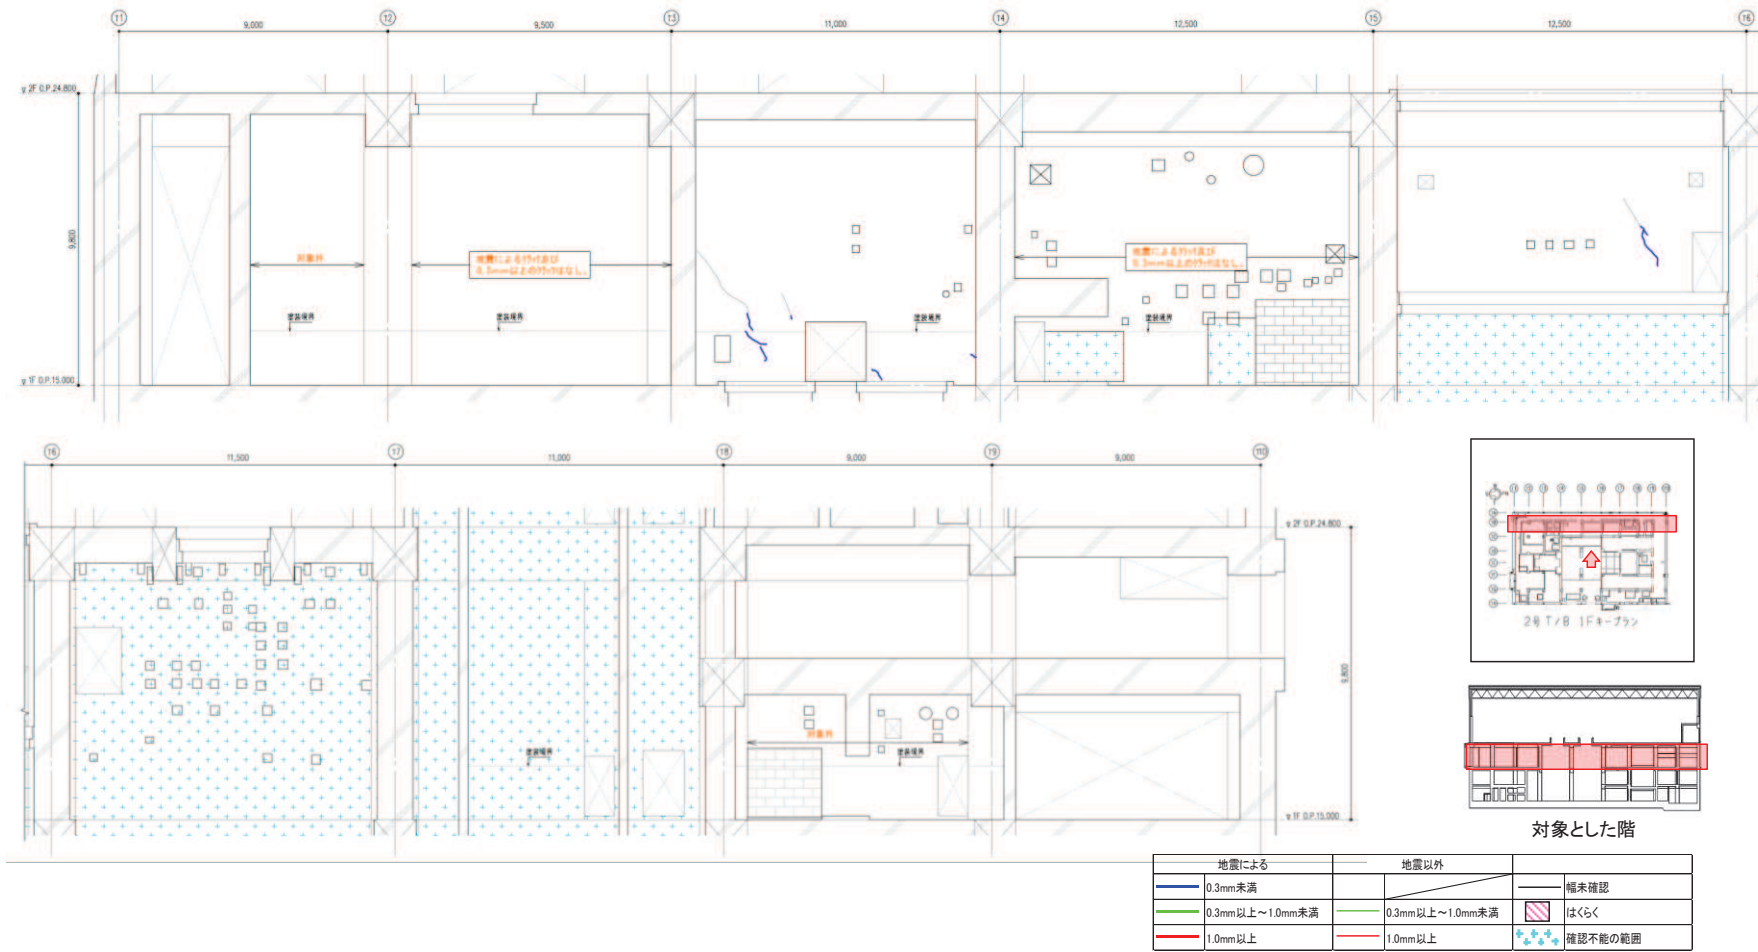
タービン建屋のひび割れ分布 耐震壁 (43) 1階 TB 通り
